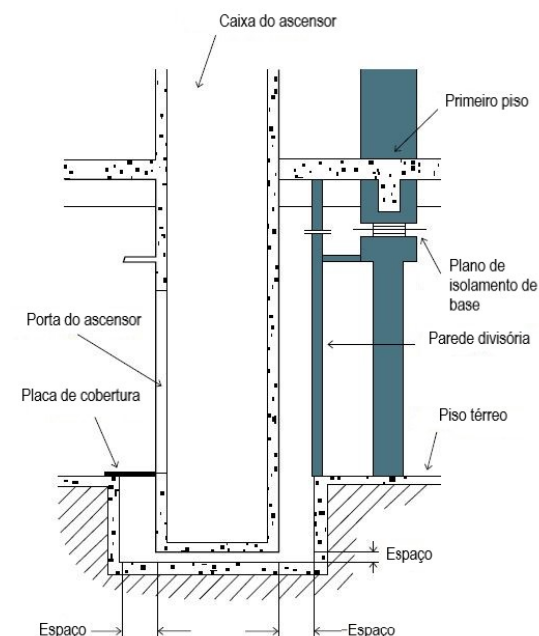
Plano de isolamento ao nível do piso térreo, com o pormenor do núcleo de elevadores, adaptado de [22].
